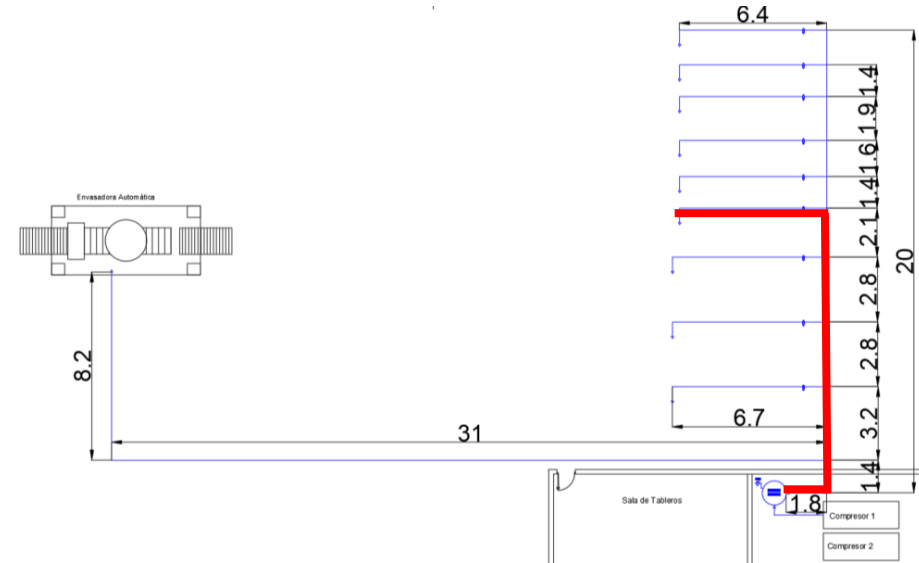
Layout verificación 6 de cañería de aire comprimido
